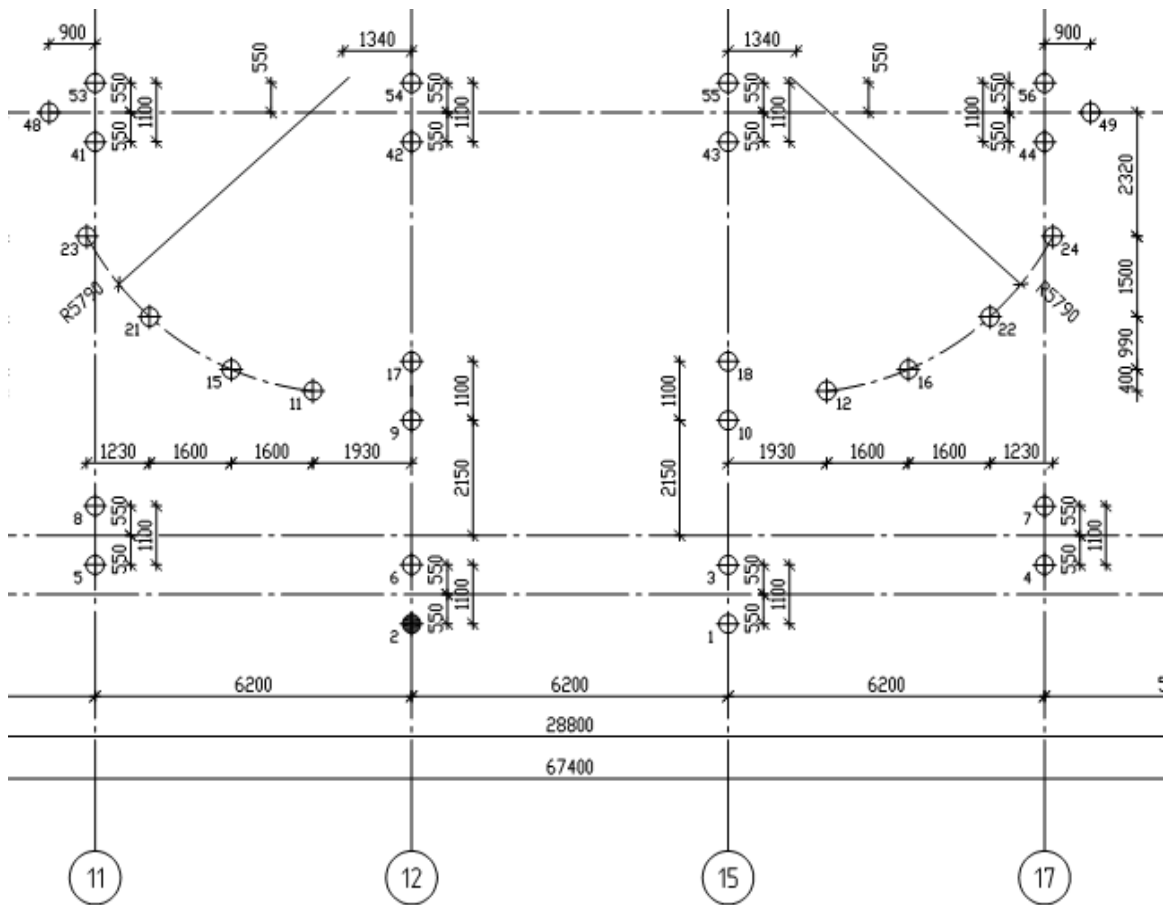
Фрагмент плану пальового поля будівлі із 588 паль
